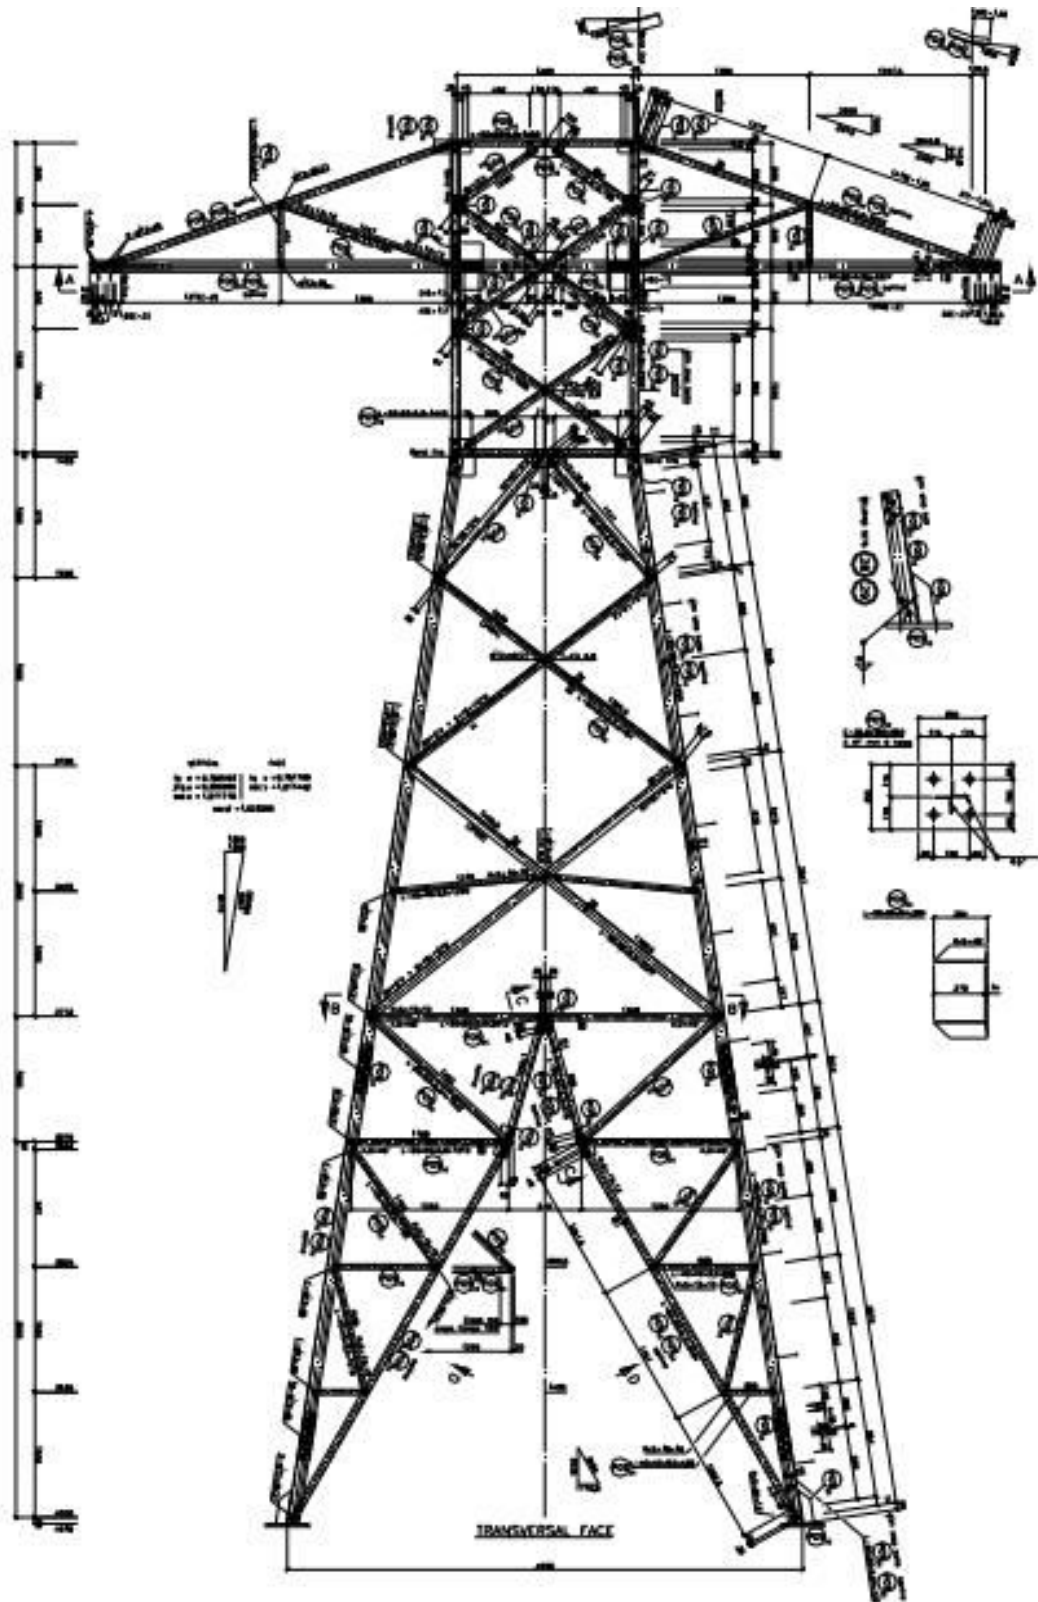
Estrutura "1" - detalhamento da face transversal.
